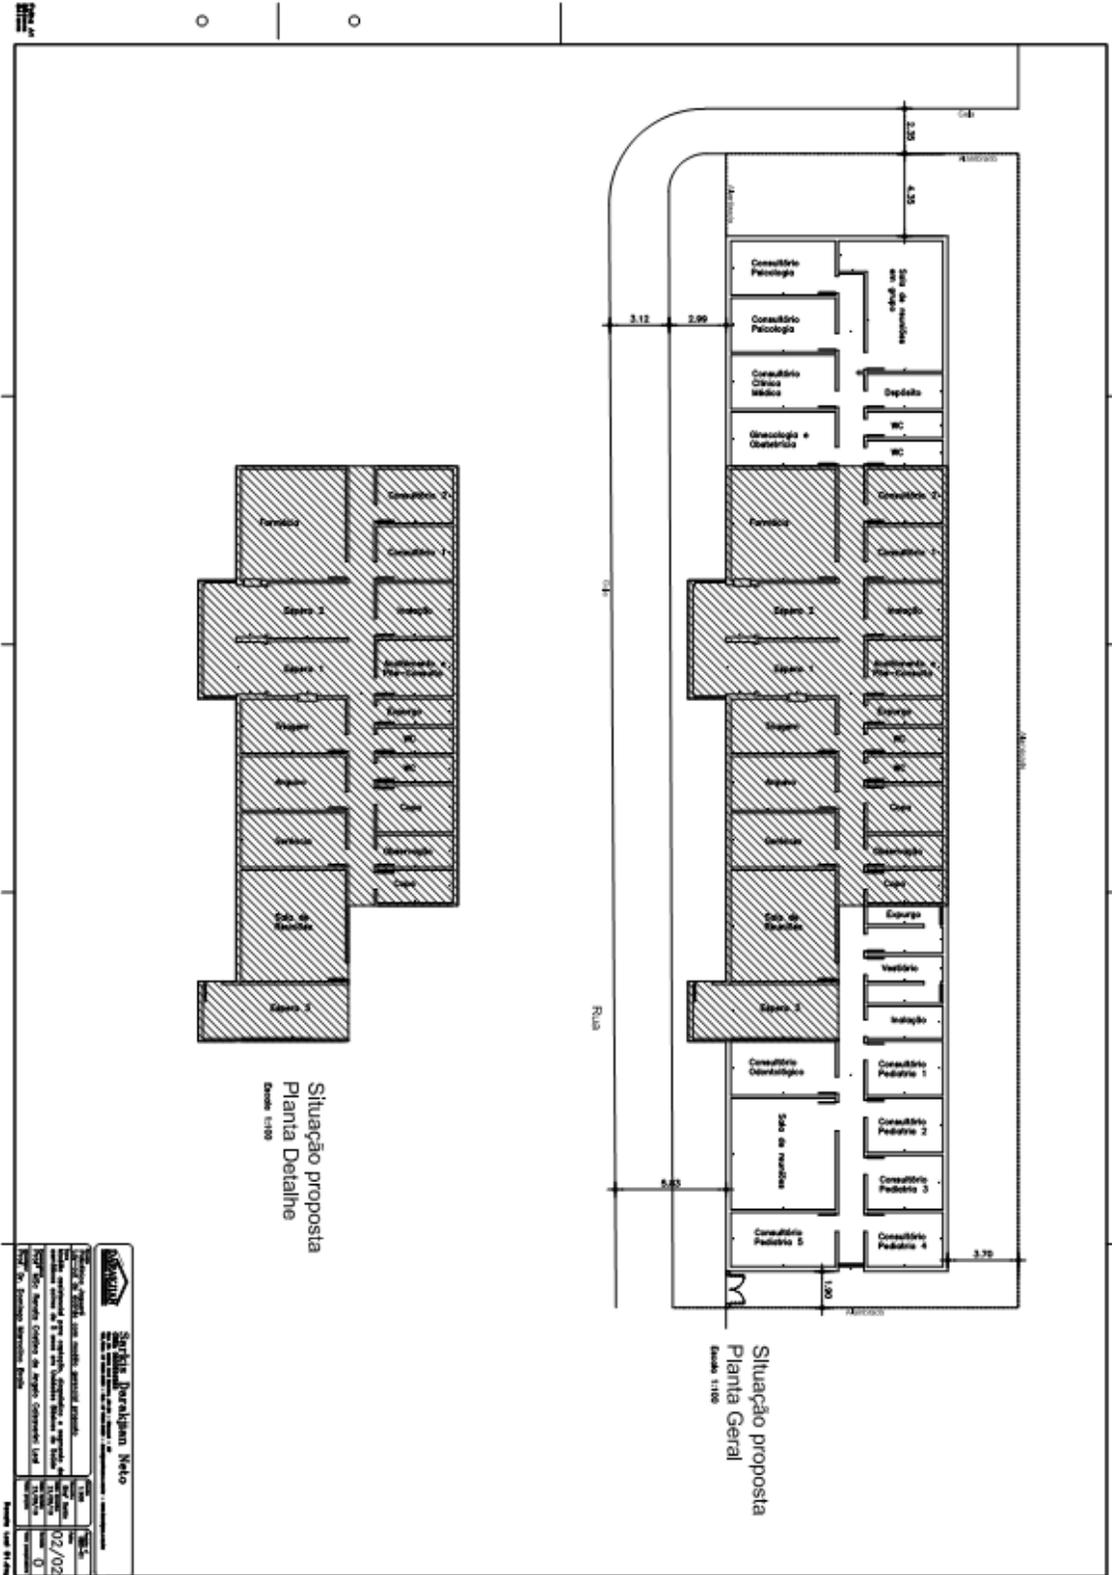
Situação proposta - Planta Detalhe / Situação proposta – Planta Geral Destacada.
